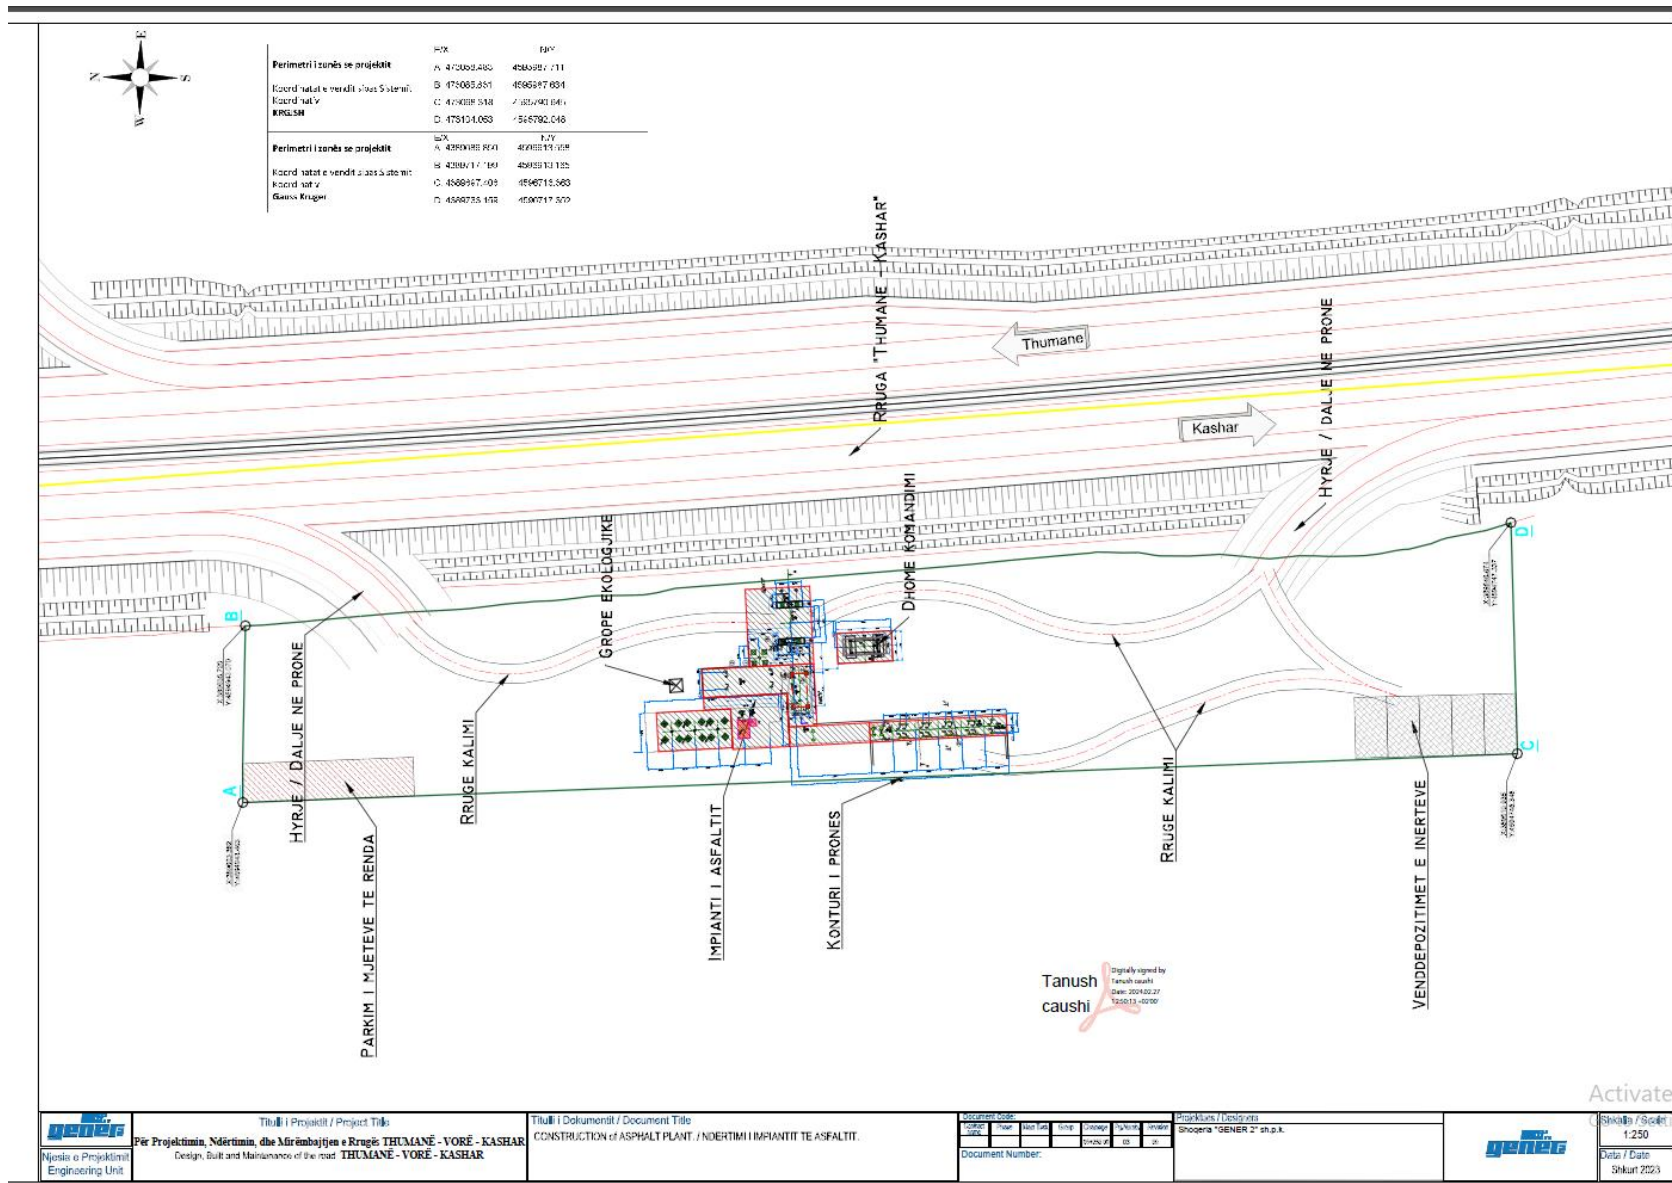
Planimetria e vendosjes së impiantit të prodhimit të asfaltit dhe organizimi i kantierit
